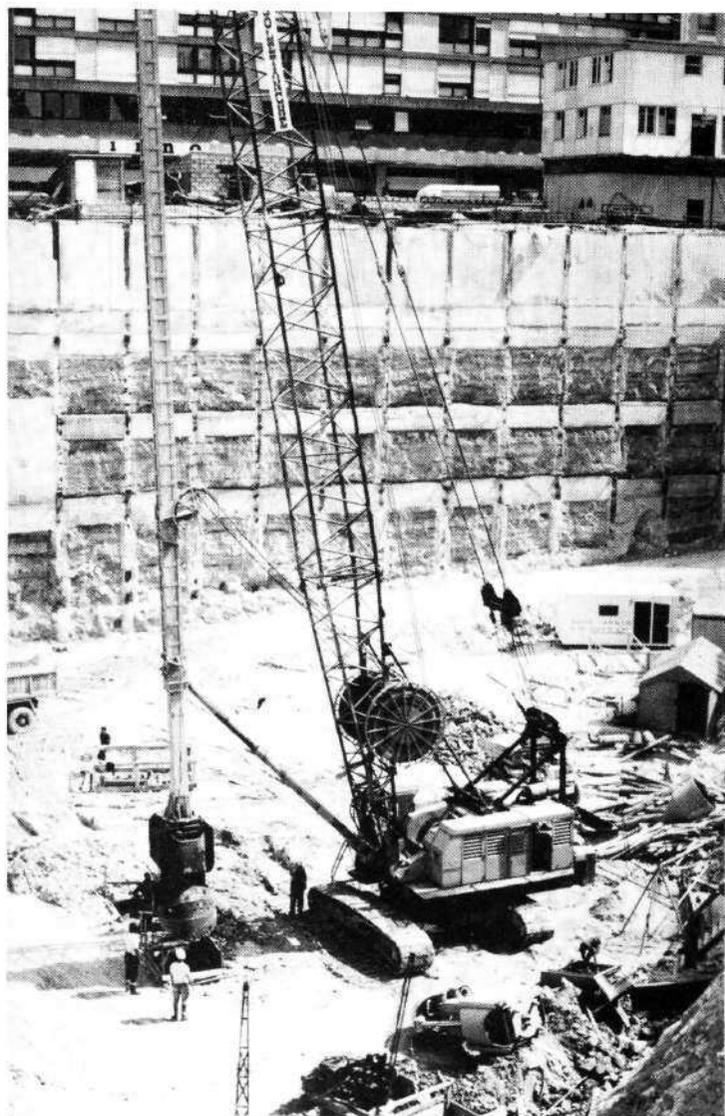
Exécution des fondations de la Tour Maine Montparnasse.
